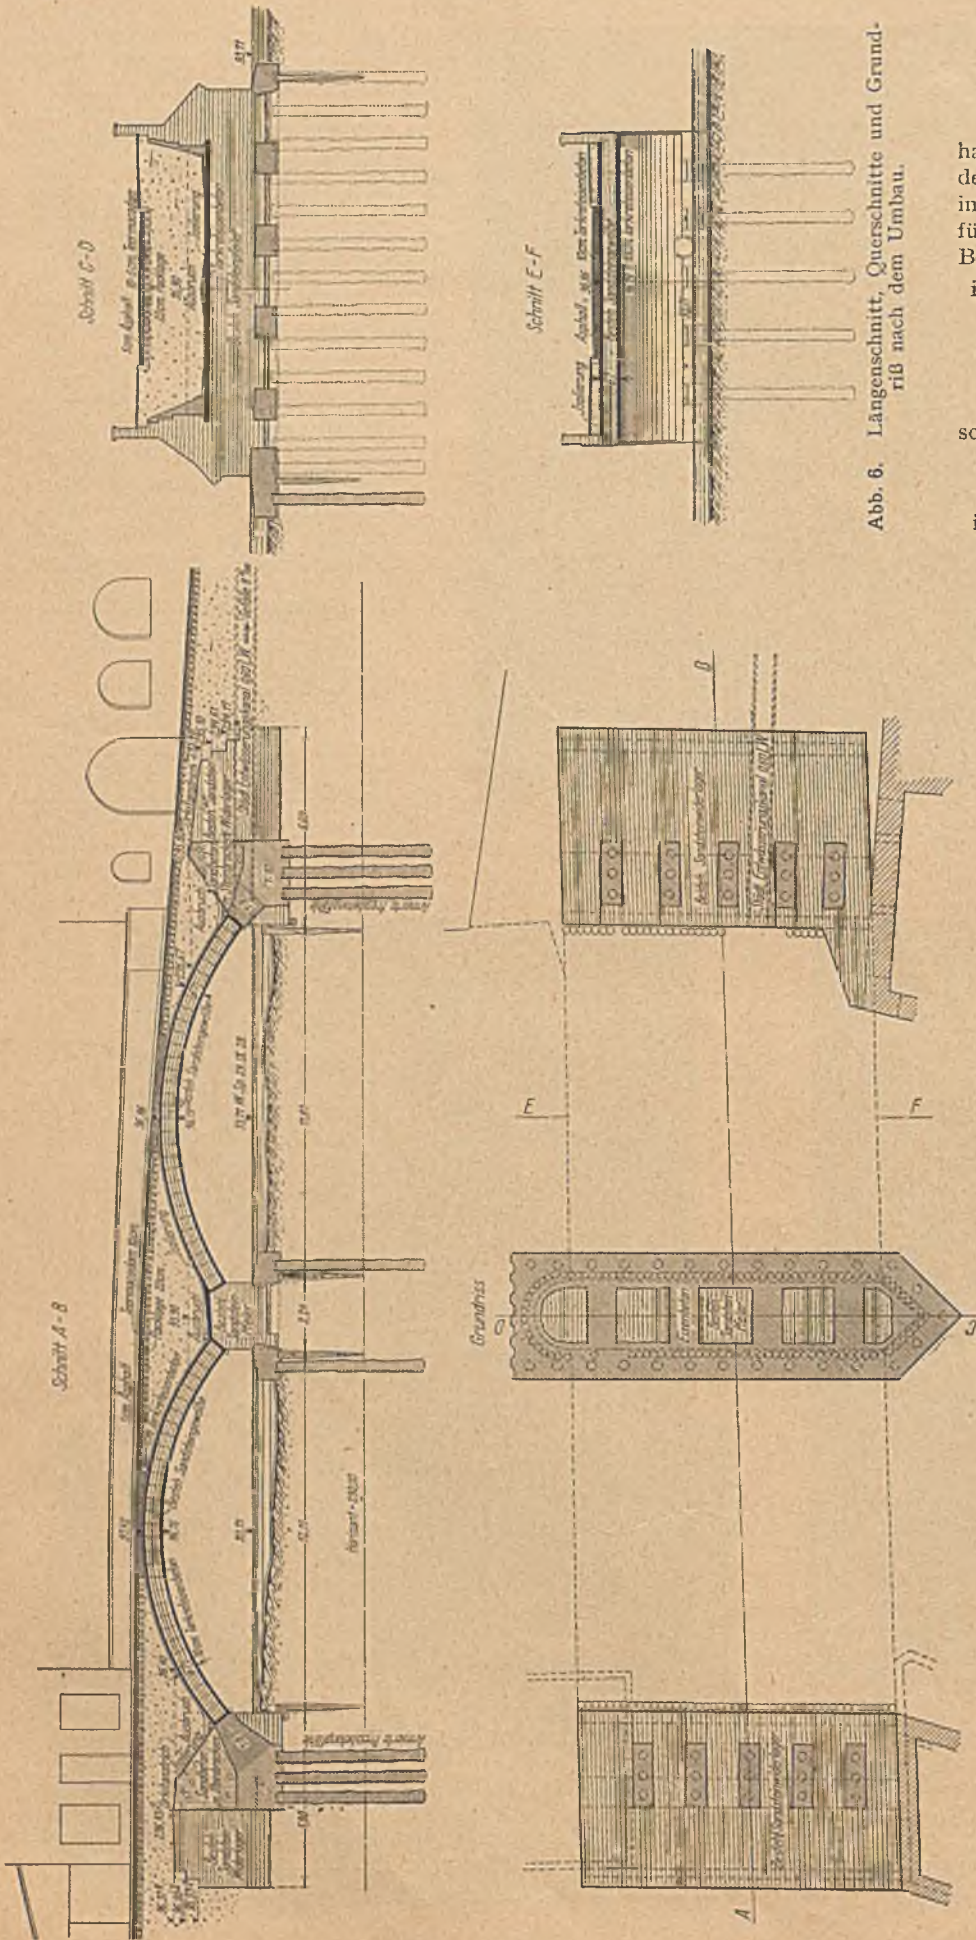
Längenschnitt, Querschnitte und Grundriß nach dem Umbau.
